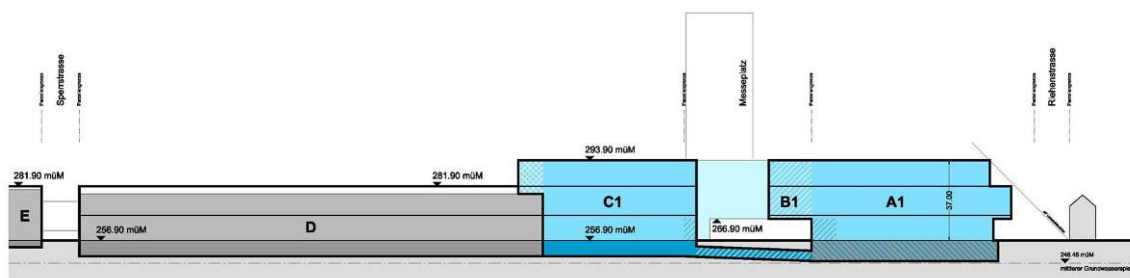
Bebauungsplan Plan-Nr. 13'241: Längsschnitt (kein Massstab)
